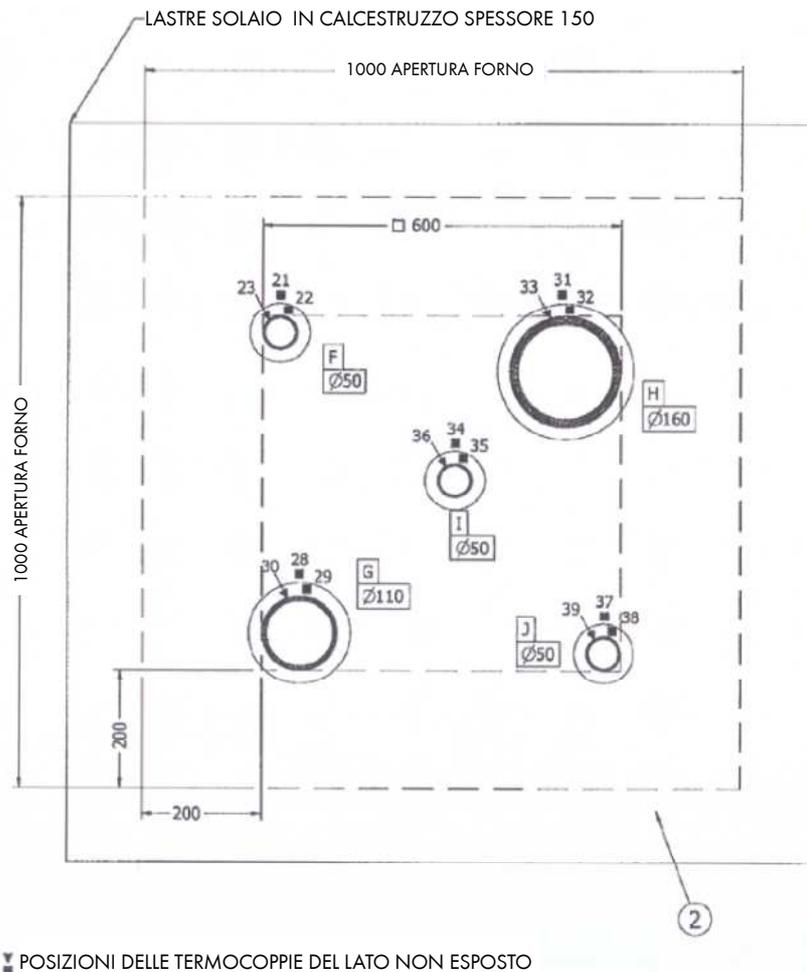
Prospetto del lato non esposto della parete illustrante le posizioni degli attraversamenti
